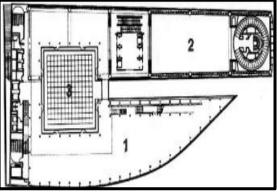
plan de 4 éme niveau. Source: Menadi, 2015.
